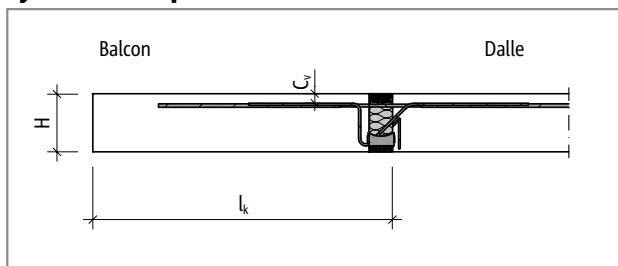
Schöck Isokorb® T Type K-E, K-T : Système statique, coupe
